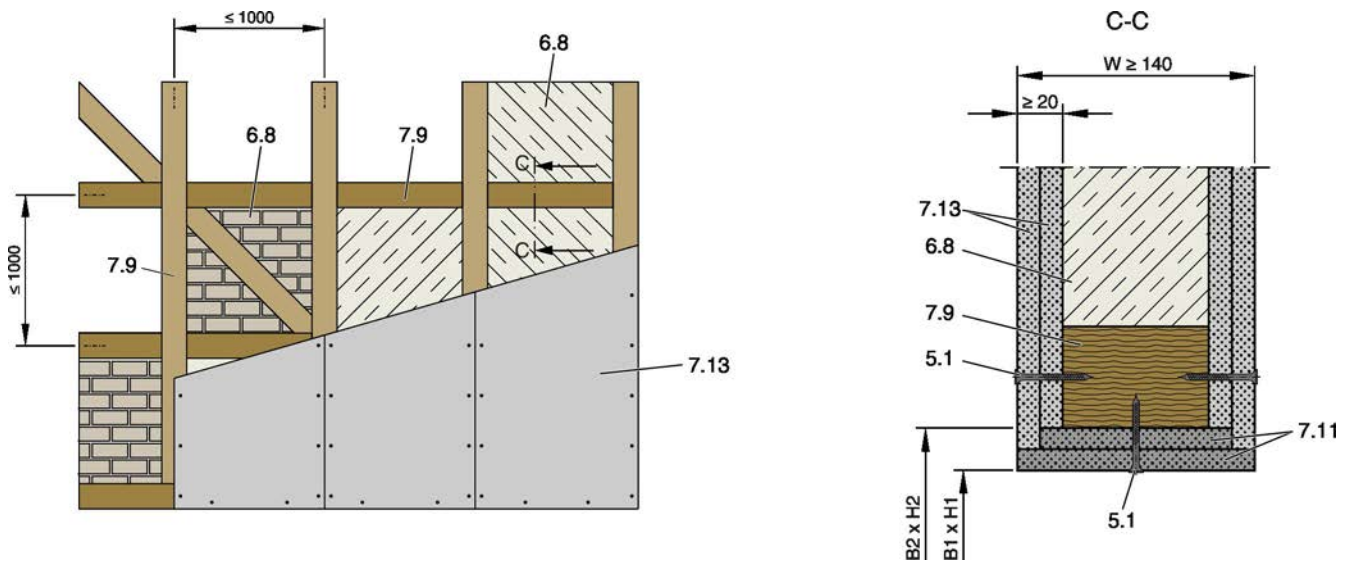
Leichtbauwand mit Holzfachwerk und beidseitiger Beplankung
